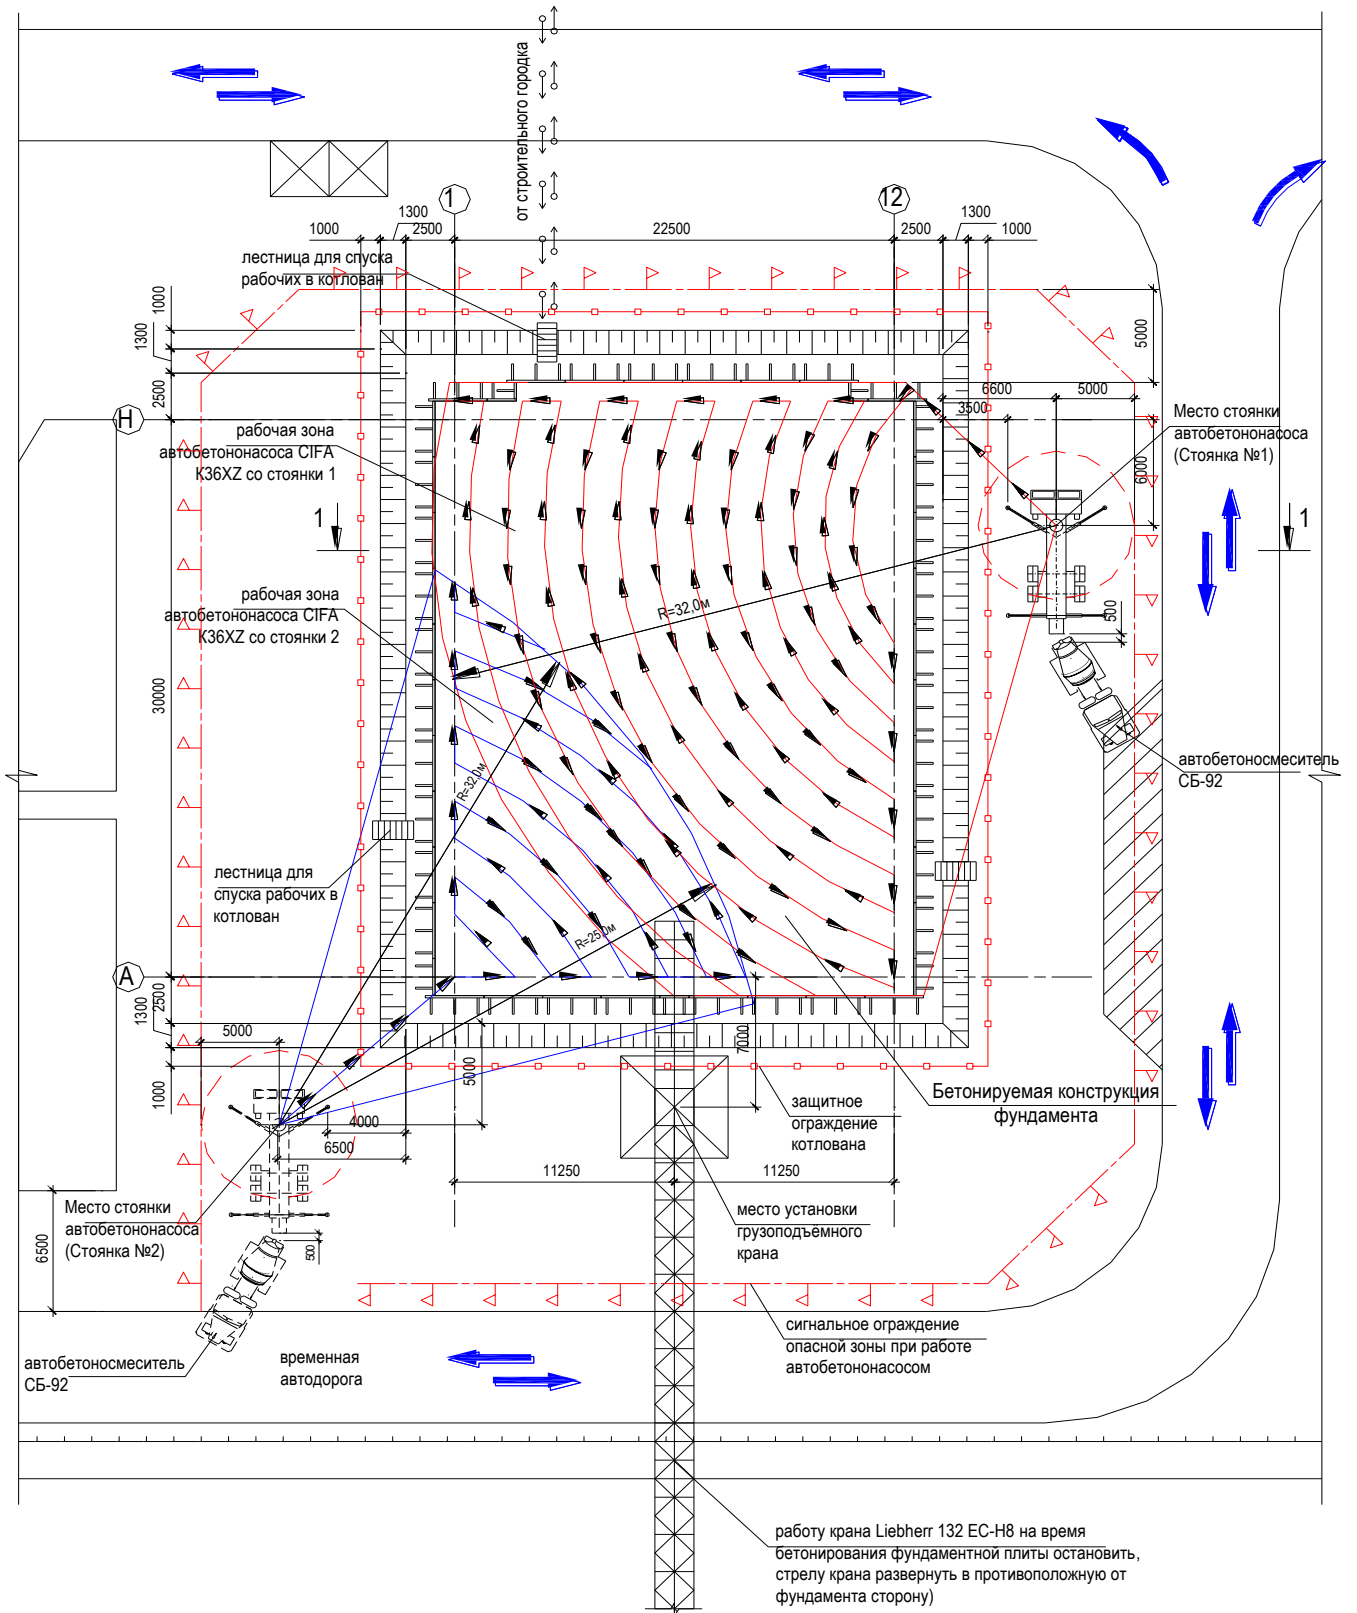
Схема производства работ по бетонированию фундаментной плиты
